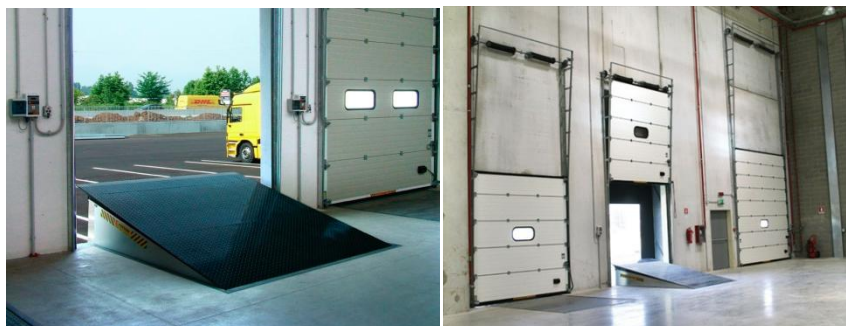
Planta a ras de suelo con muelles de aproximación empotrados equipados con rampas.
